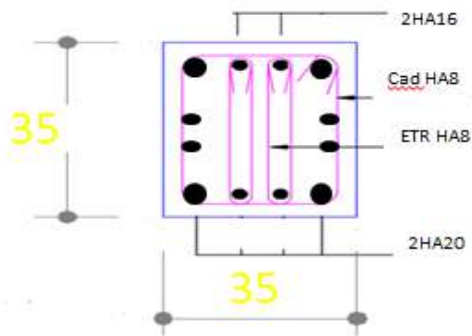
Ferrailage des poteaux de RDC 5ème et 6ème étage.
